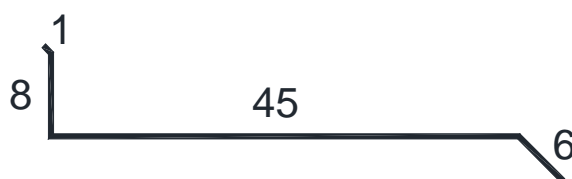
Perfil do rufo a ser instalado entre as platibandas e as telhas, sobre os rufos existentes.
